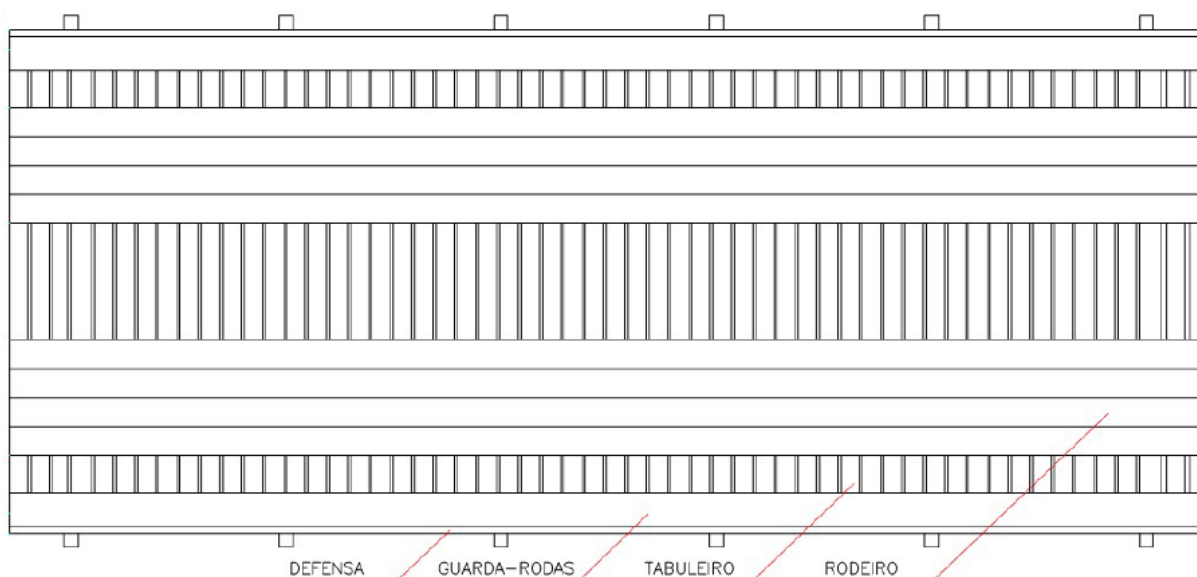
Vista superior dos elementos comumente encontrado nas pontes de madeira em vigas roliças
